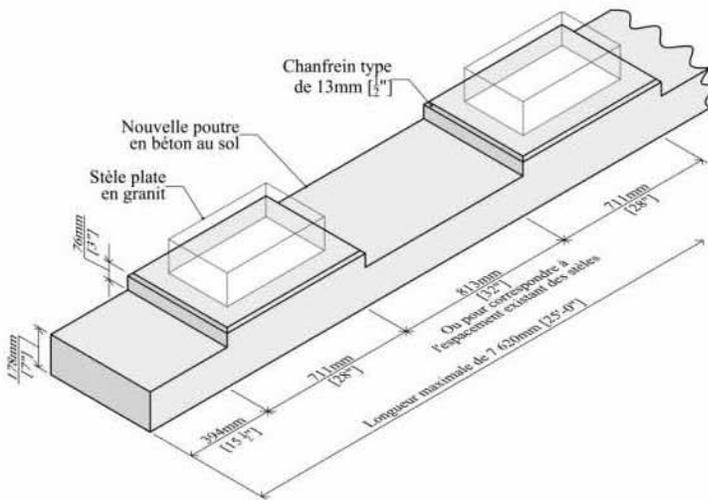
(ii) : Poutre de fondation reposant sur le sol pour stèles plates et stèles commandées spécialement – poutre enterrée, stèle surélevée au-dessus du gazon.
